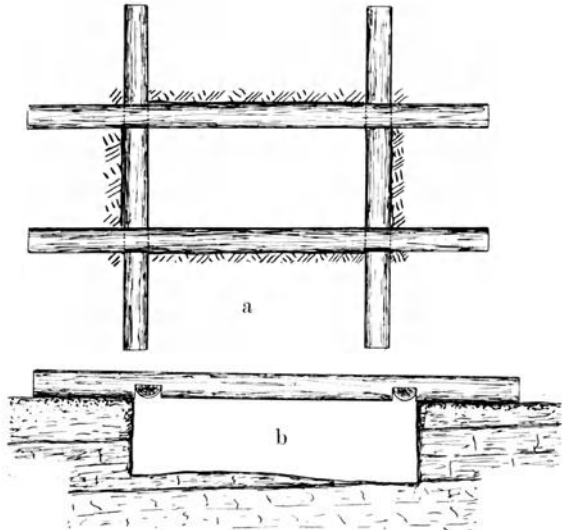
Rasengeviert. a) Grundriß, b) Aufriß.
